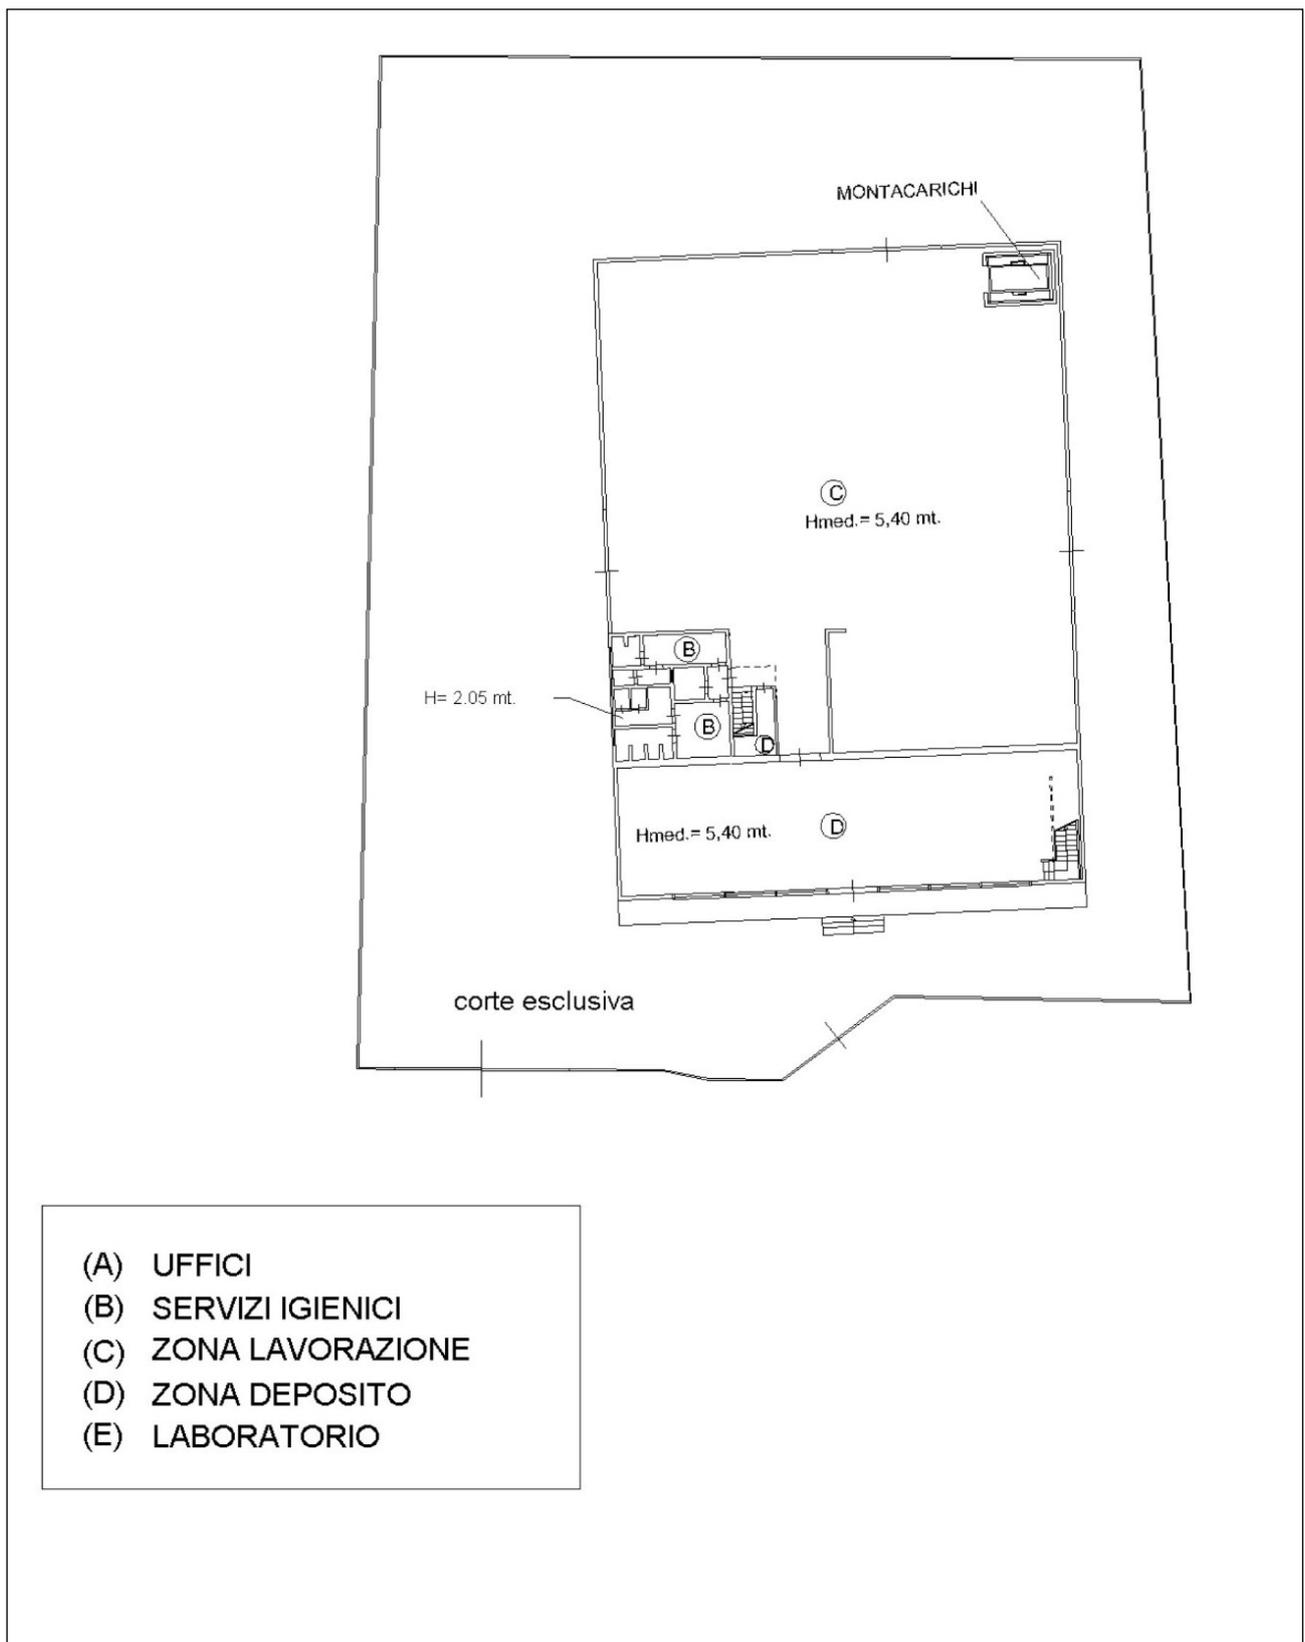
Stralcio della planimetria catastale del 06/05/2008. Piano terra.
